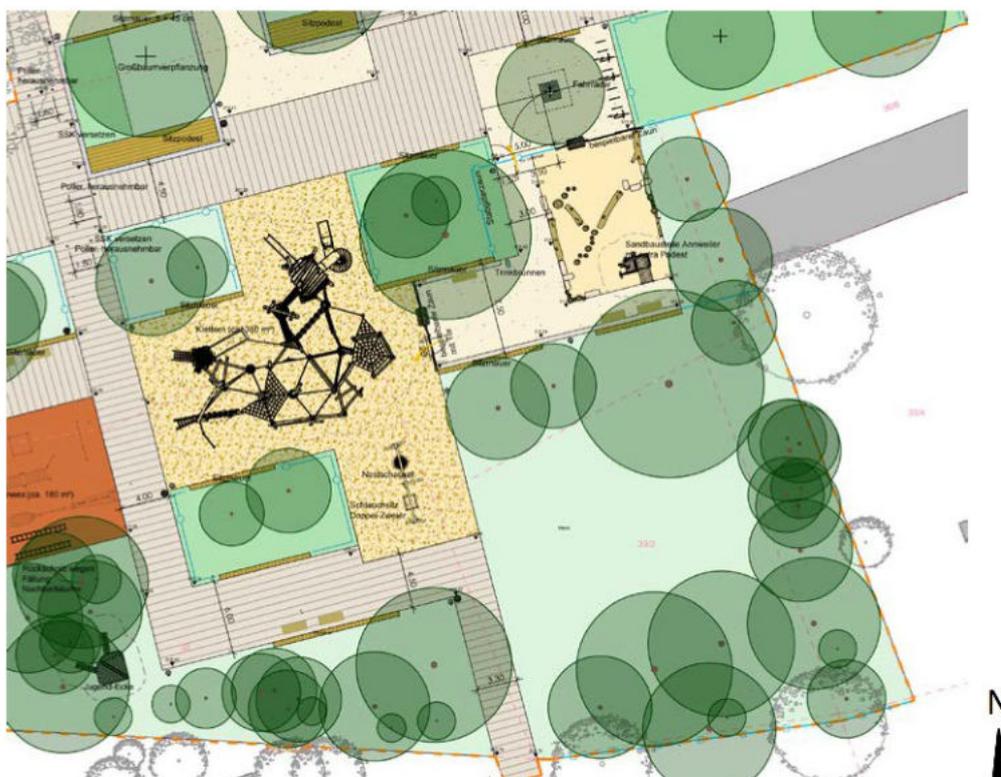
Lageplanausschnitt Entwurf Spielbereich
